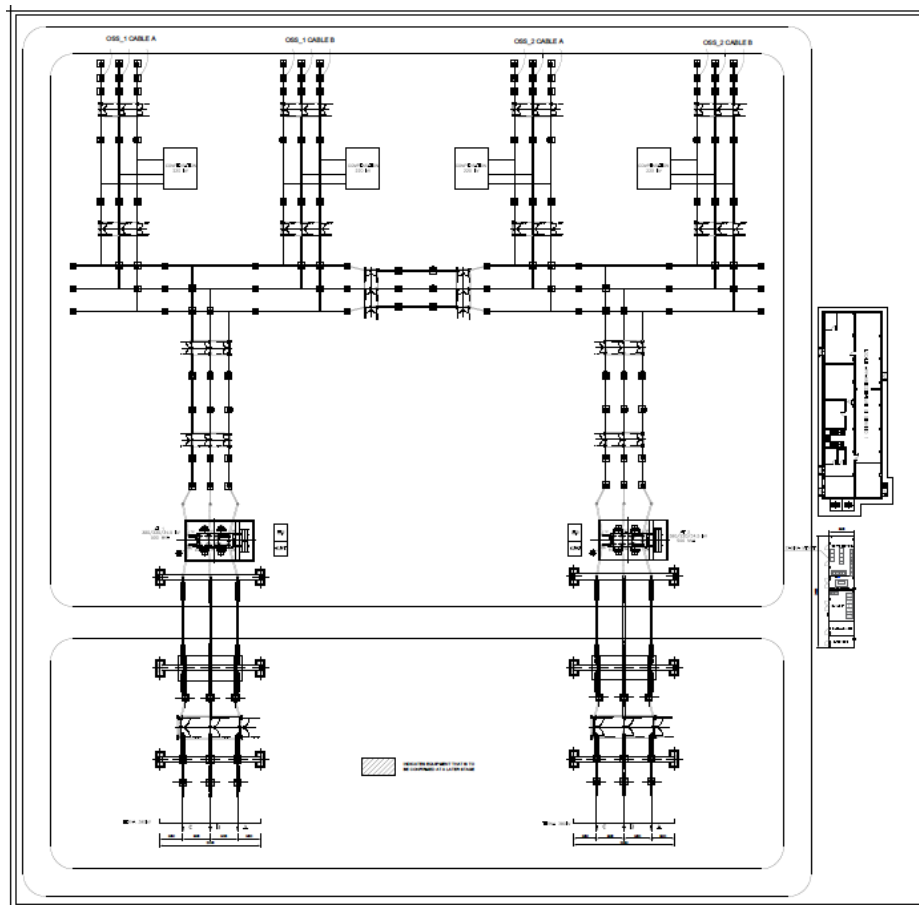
Vista in pianta della Stazione Elettrica Utente
